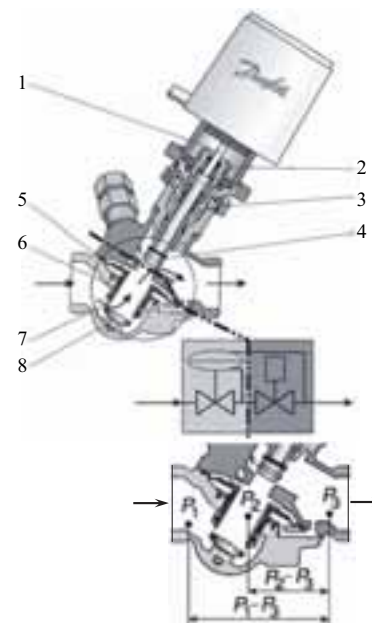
Клапан АВ-QM: 1 – шток; 2 – сальник; 3 – кольцо со шкалой настройки; 4 – затвор; 5 – мембрана; 6 – пружина; 7 – трубчатый шток; 8 – неподвижный затвор
